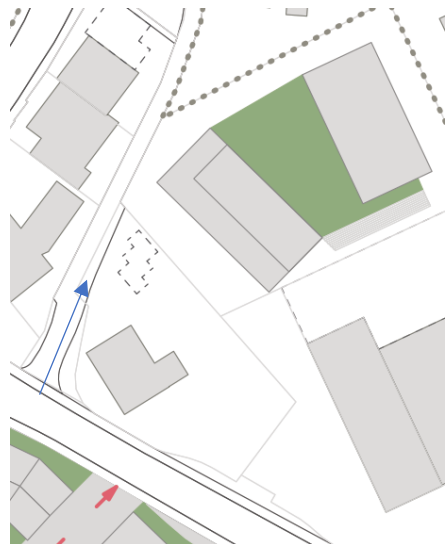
Erschliessung und Parkierung oberirdisch (gestrichelt nur Anlieferung)
